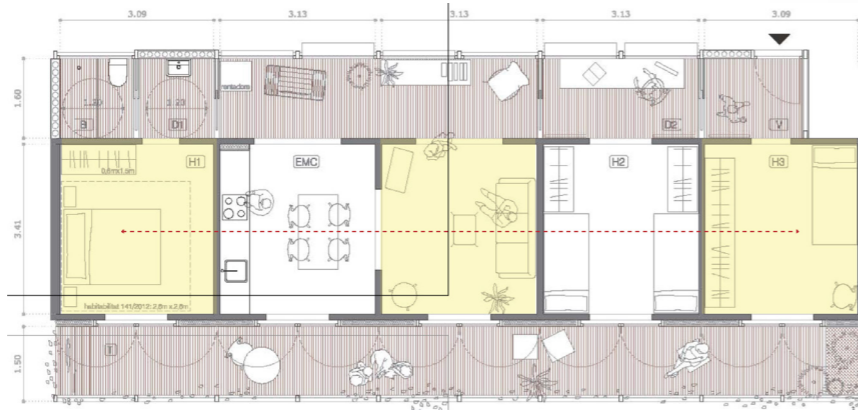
, Planta apartamento, 136 viviendas en Gavá, H arquitectes, 2019
